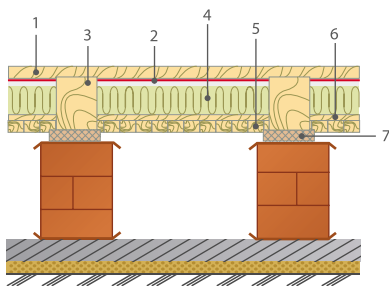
Перекрытие над холодным подпольем по кирпичным столбикам:
